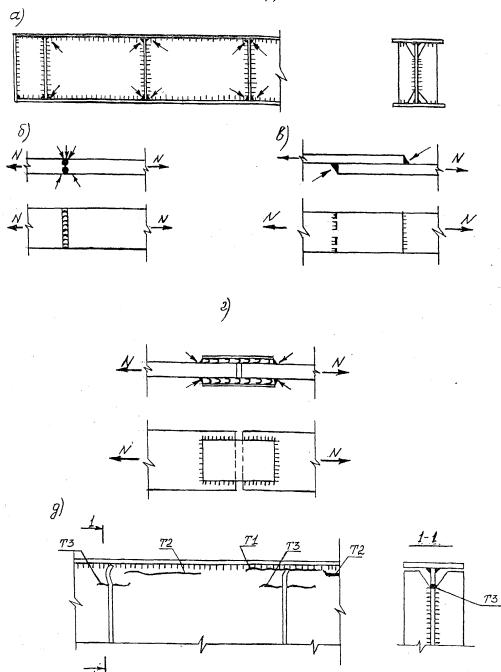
Места зарождения усталостных трещин в стальных конструкциях а - в соединениях прикрепления ребер жесткости балок к сплошной стене; б - в стыковых соединениях; в,г - в нахлесточных соединениях; д - в верху подкрановых балок; Т1 - трещина по сварному шву; Т2,Т3 - по металлу
